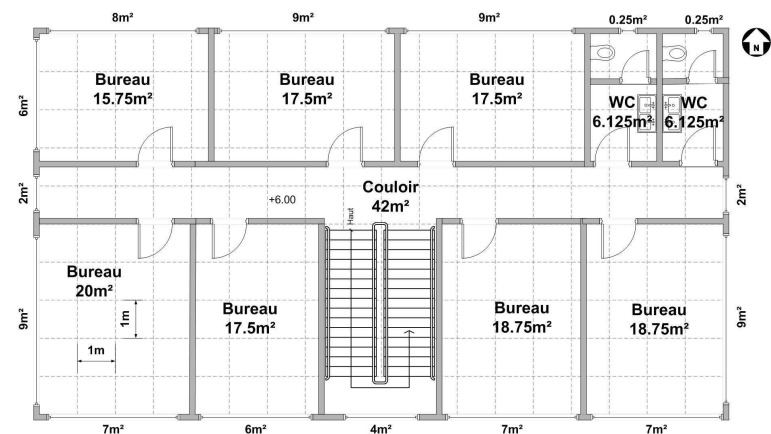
Plan du 2^{ème} étage du bâtiment Beethoven
